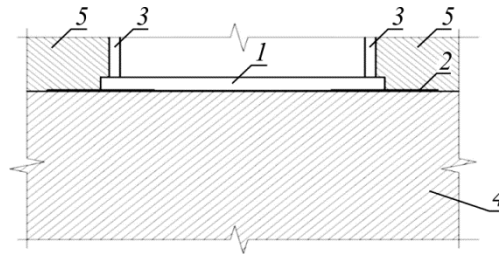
Подготовка, армирующая основание фундаментной плиты, с защемлением краев полотна геосинтетического материала в плоскости подошвы фундамента: 1 – фундаментная плита; 2 – армирующий геосинтетический материал; 3 – стены подвала; 4 – грунт основания; 5 – уплотненный грунт обратной засыпки пазух фундамента
